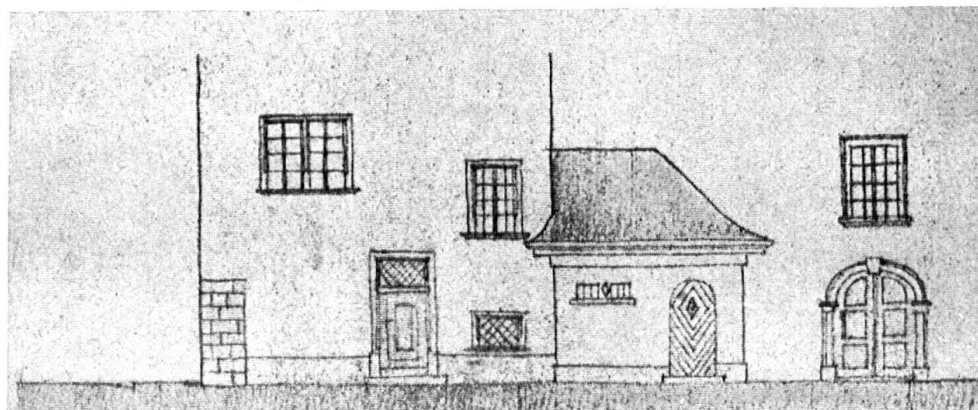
und 11. Entwurf „November“. Grundriss im Situationsplan und Ansicht. 5. Preis. Verfasser: Konrad Kreis, Bautechniker, Ermatingen. Lösung gedacht in vorhandene Ecke bestehender Gebäude; massiv, verputzt, der Umgebung sich anpassend. Bedachung in Biber-schwänzen. — Fig. 10 et 11. Projet „November“, plan du bâtiment et de sa situation, vue générale. 5^e prix. Auteur: Konrad Kreis, Ermatingen. Construction à établir dans un angle de rue déjà existant. Murs massifs, crépi en harmonie avec l'architecture voisine. Toiture à tuiles plates.
